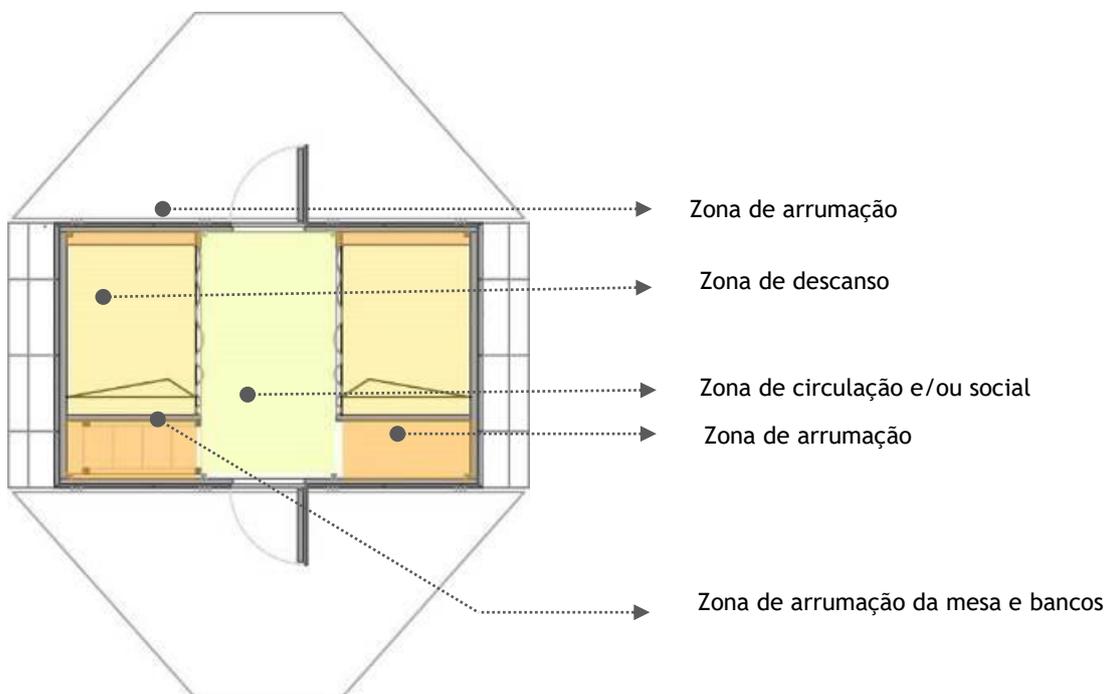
Planta Cota 0,41 esquemática da distribuição de zonas
